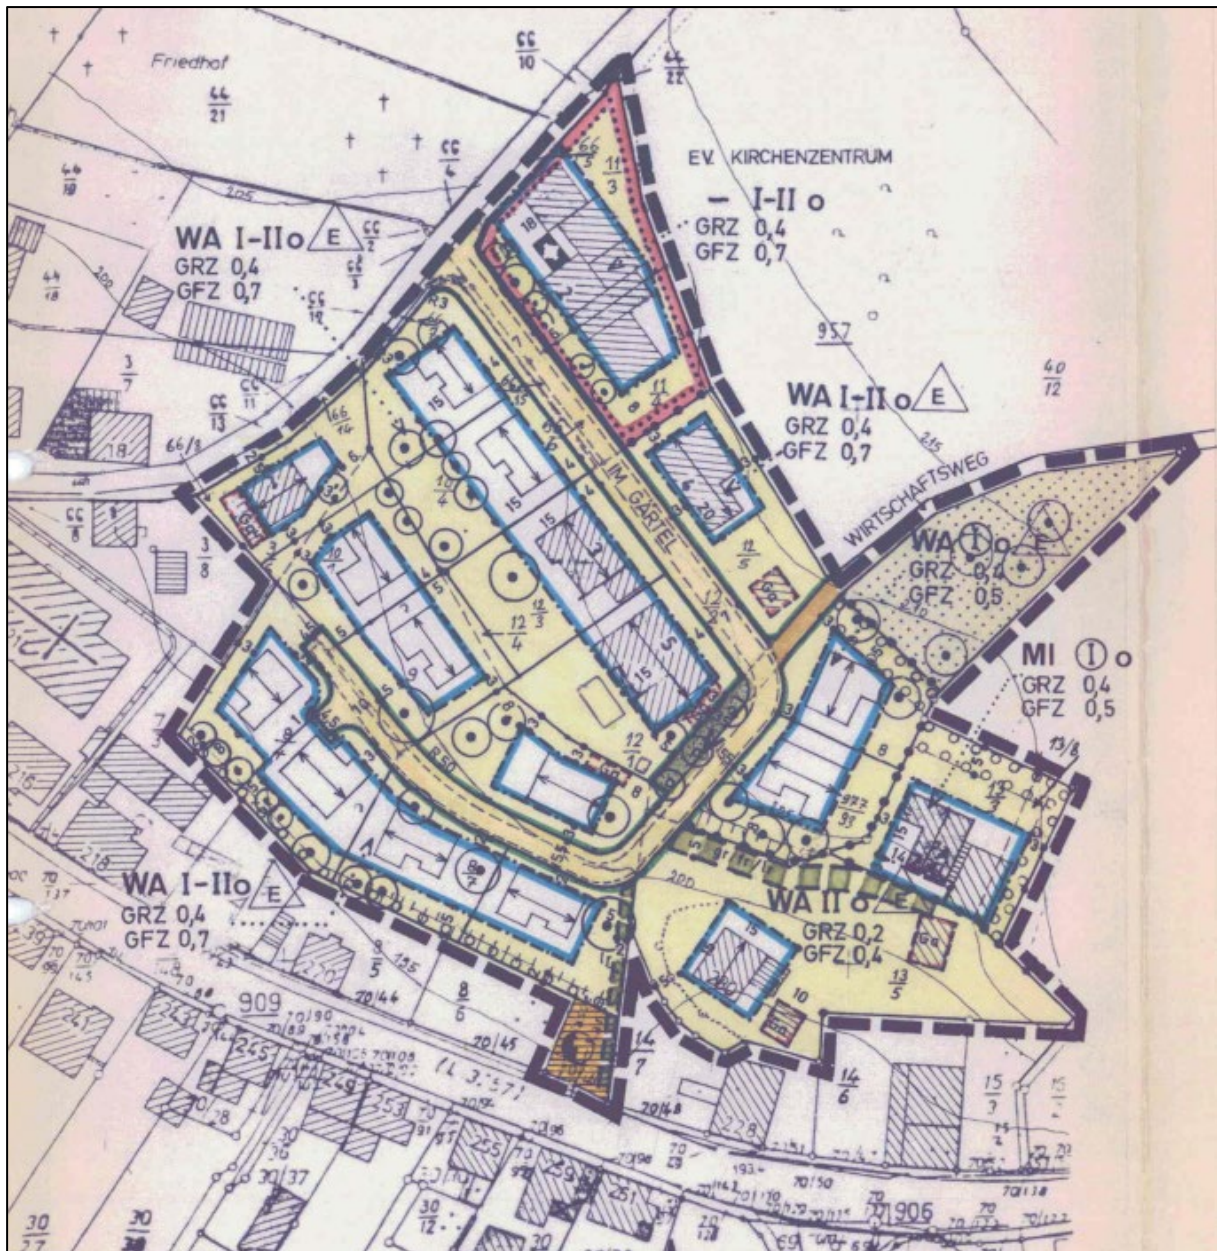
Planzeichnung des Bebauungsplans „Im Gärtel“
